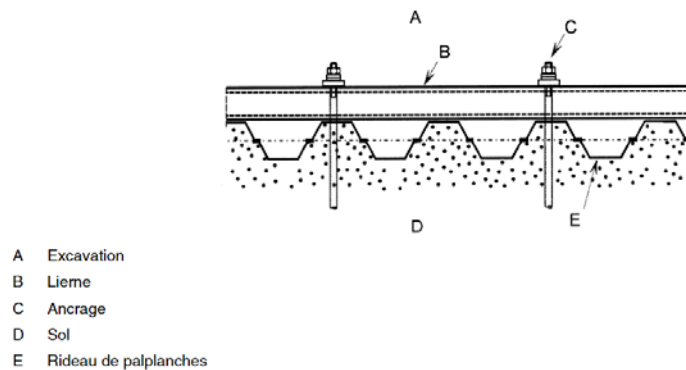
Exemple de lierne devant le rideau de palplanches
